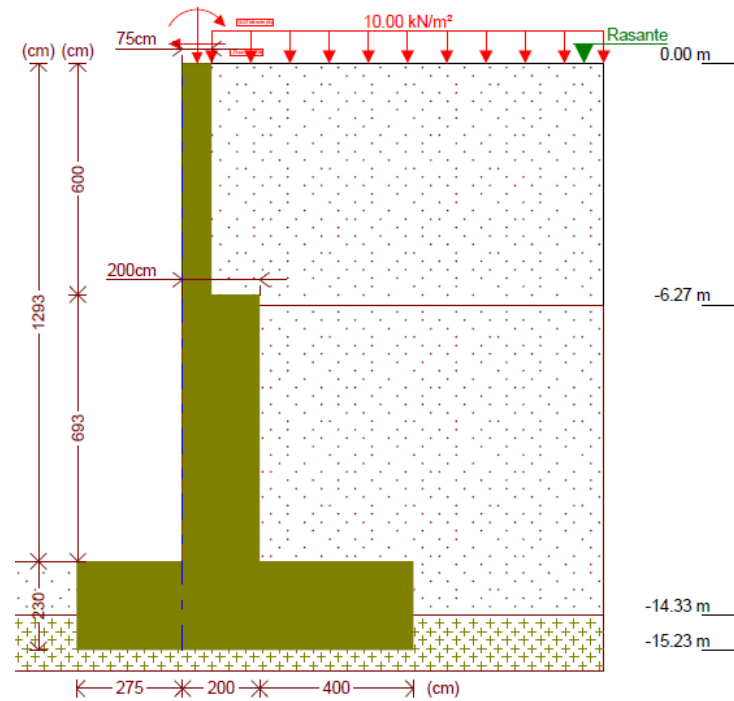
Alzado del muro de vuelta en el estribo 2
